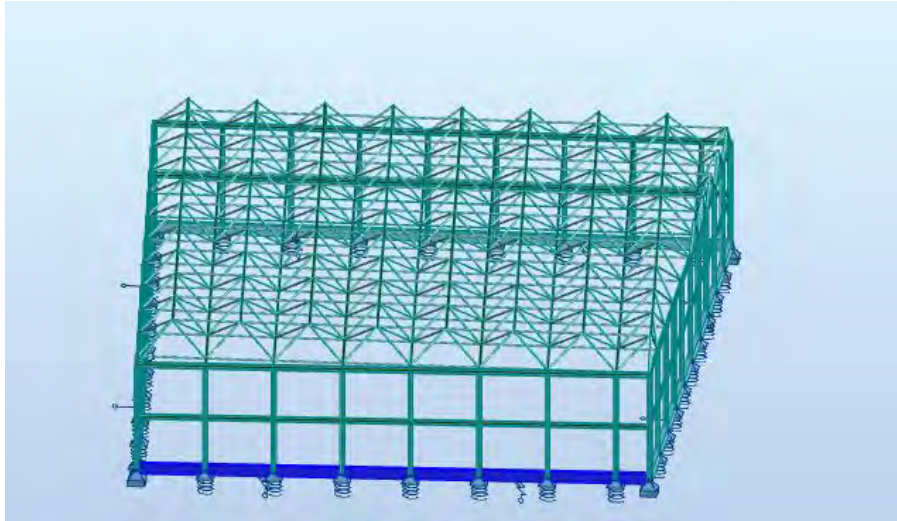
FIGURA DETALLE DE SITUACIÓN 13.20.- DETALLE DE SITUACIÓN
